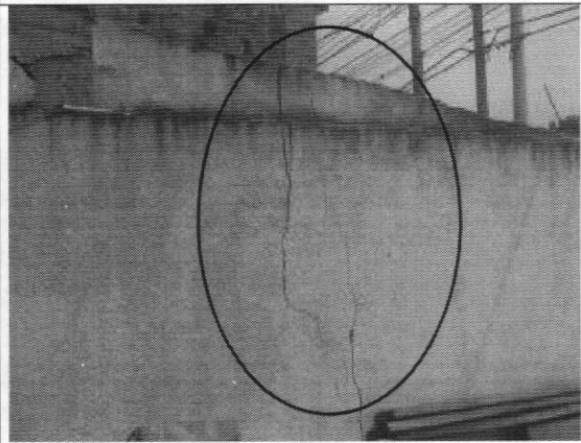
Agrietamiento en muro de cerramiento frontal, costado norte
